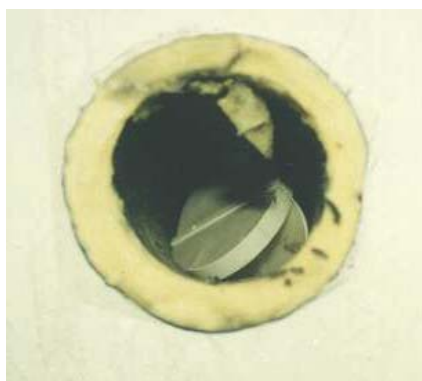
Falsch eingebaute Sturmbremse in einer Weichschaum-Wanddurchführung
